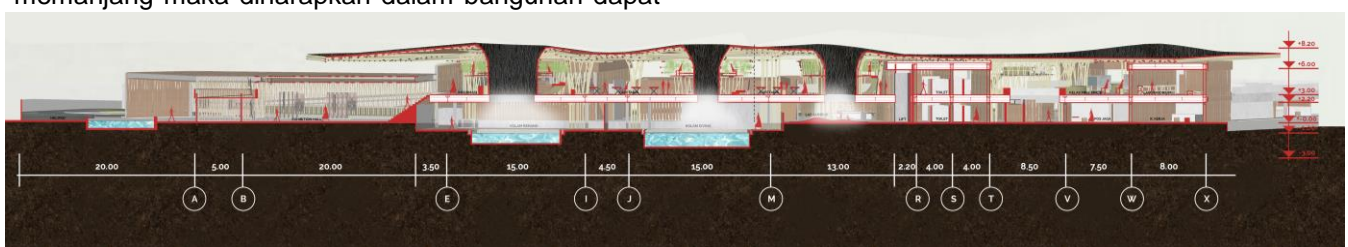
8. Potongan Membujur dan Tampak Barat
